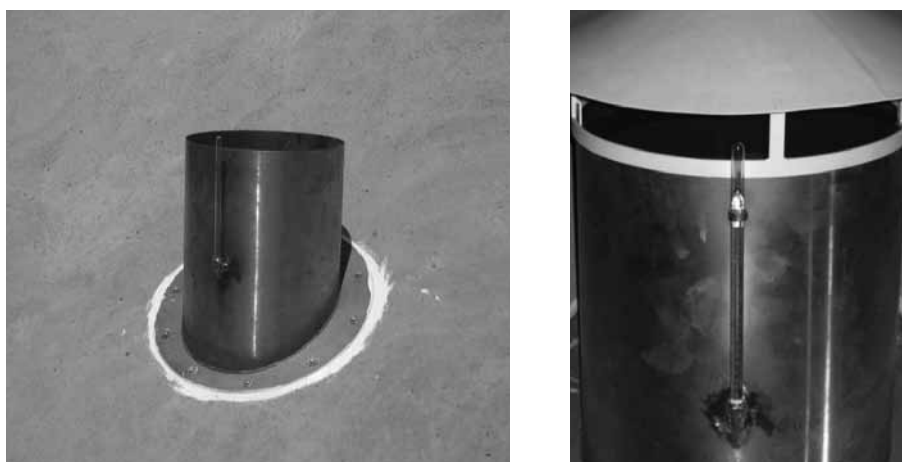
Aparato utilizado para teste de estanqueidade do betão de impermeabilização em espaldas e rasto de canal
